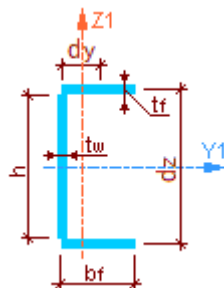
Схема профиля Швеллер сварной
